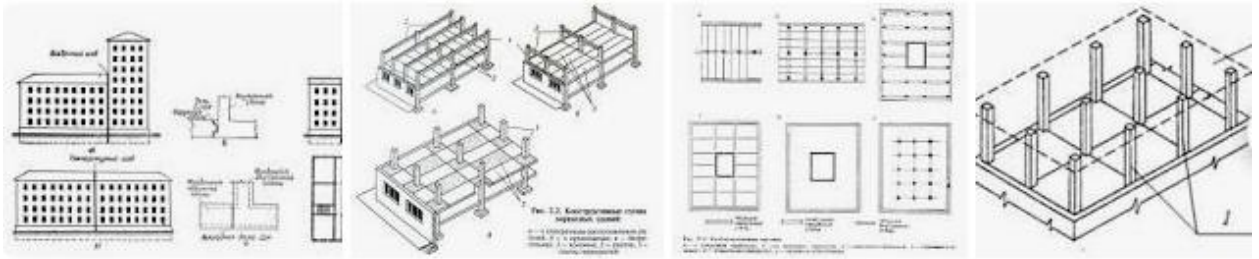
Конструктивна схема будівлі з безригельной каркасом
